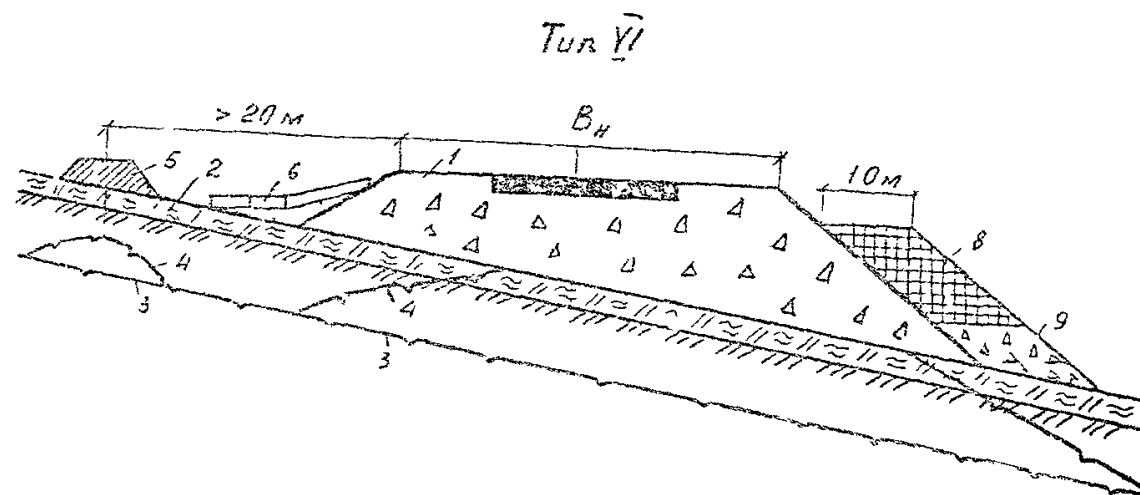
Поперечный профиль насыпи на льдонасыщенном косогоре крутизной менее 1:5 : 1 – нецементированный обломочный грунт; 2 – мохорастительный покров; 3 – ВГЗМ до постройки насыпи; 4 – ВГЗМ после постройки насыпи; 5 – нагорный мерзлый валик; 6 – укрепление бетонными плитами на слое мохоторфа; 7 – тепло-изоляция из мха или торфа толщиной не менее 0,5 м; 8 – глинистый грунт толщиной 15–20 см; 9 – дренажирующая присыпка
